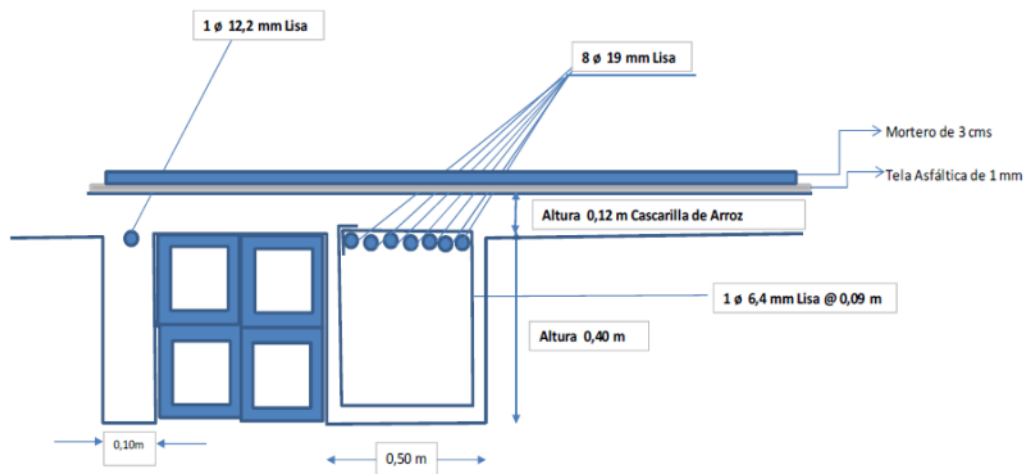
Viga C entre Ejes 6-7 Quinto Piso Cuarta Placa
